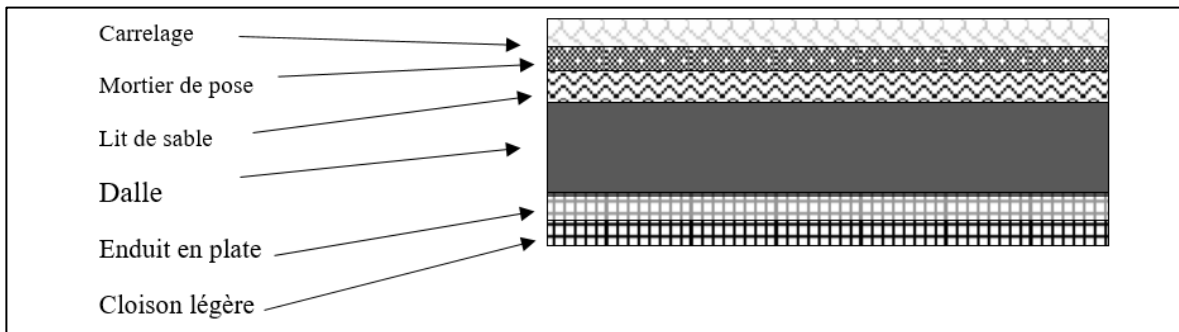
Coupe verticale du plancher courant à dalle pleine.
